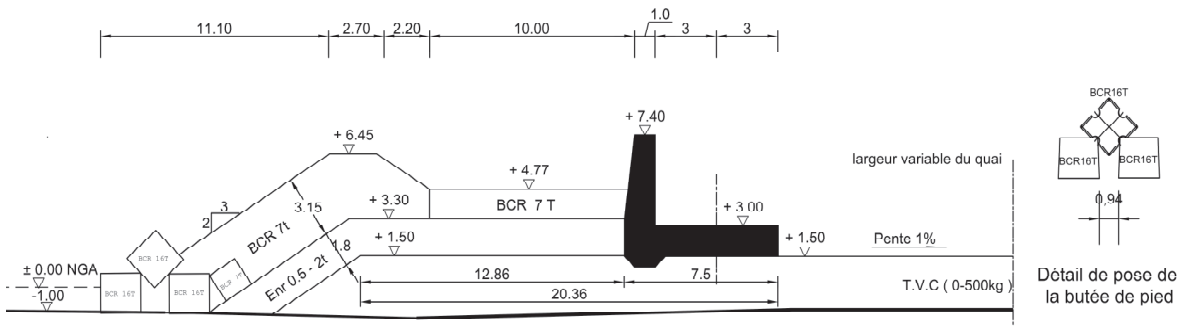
Coupe transversale 1 du profil enracinement de la jetée principale
